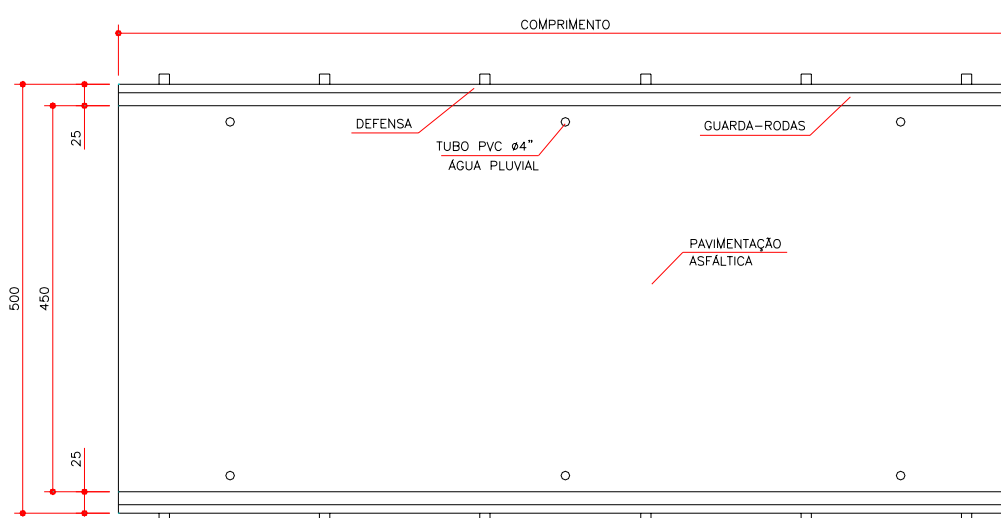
Vista superior da ponte em placa mista de madeira-concreto
